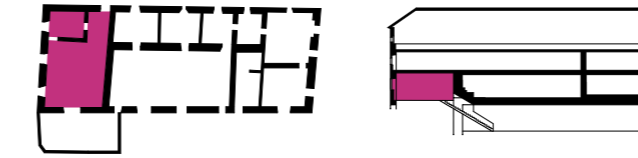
und 67 l: Öffnung F04 r: Parapet vermutlich nachträglich aufgemauert
